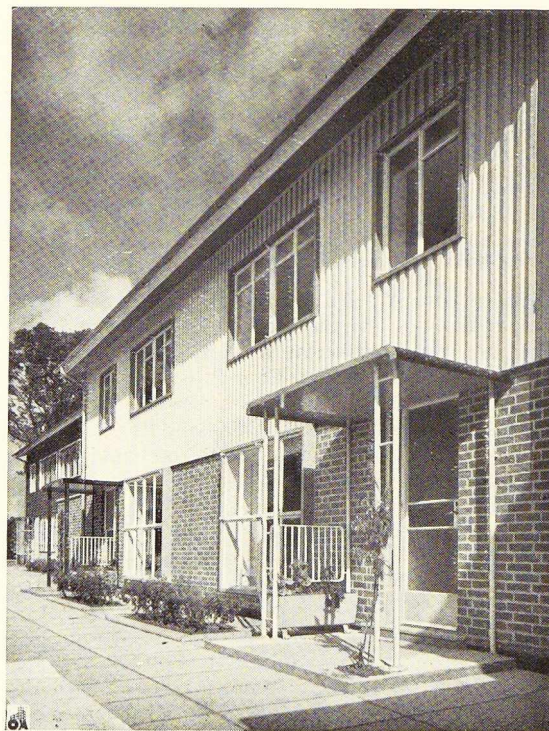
Façade de la maison A. Au rez-de-chaussée, revêtement en brique, au premier étage, tôle pliée en queue d'aronde peinte.
